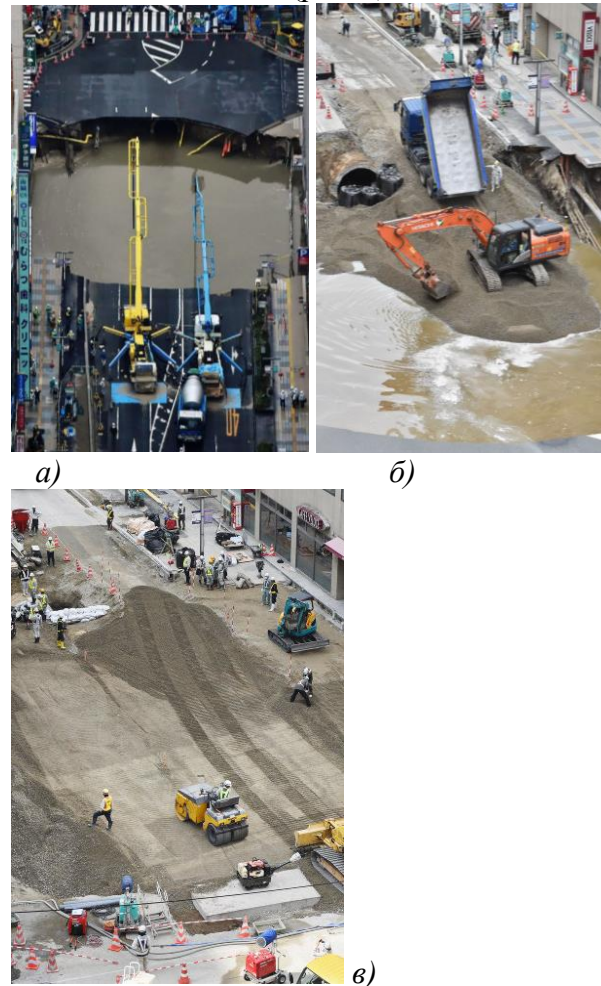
Поетапне ліквідування провалу ґрунтового масиву: а) бетонування простору; б), в) засипання спеціалізованим ґрунтом
